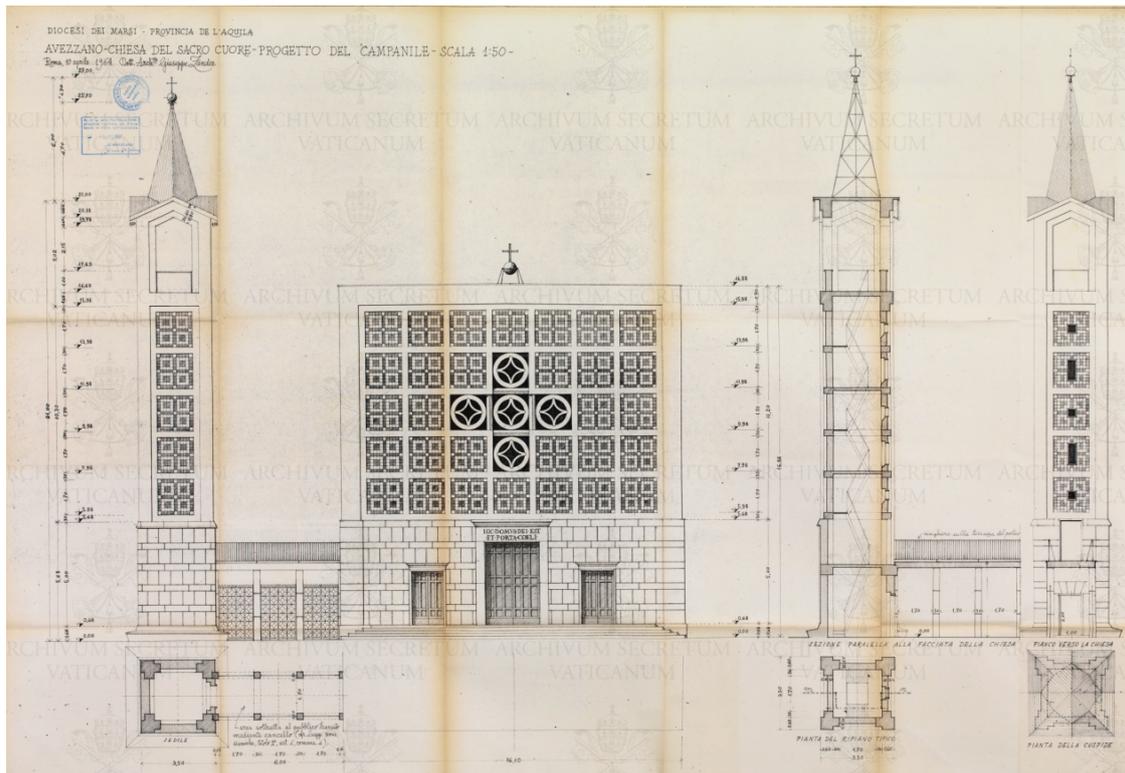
1964 - Progetto del campanile della chiesa del Sacro Cuore in Avezzano - piante, prospetti, sezione (ASV)
